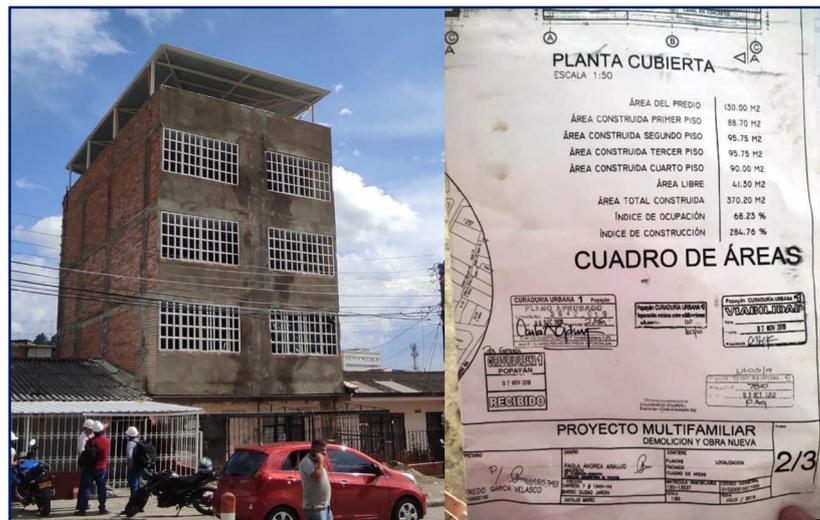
Fachada – Plano con sellos de Curaduría Urbana 1
